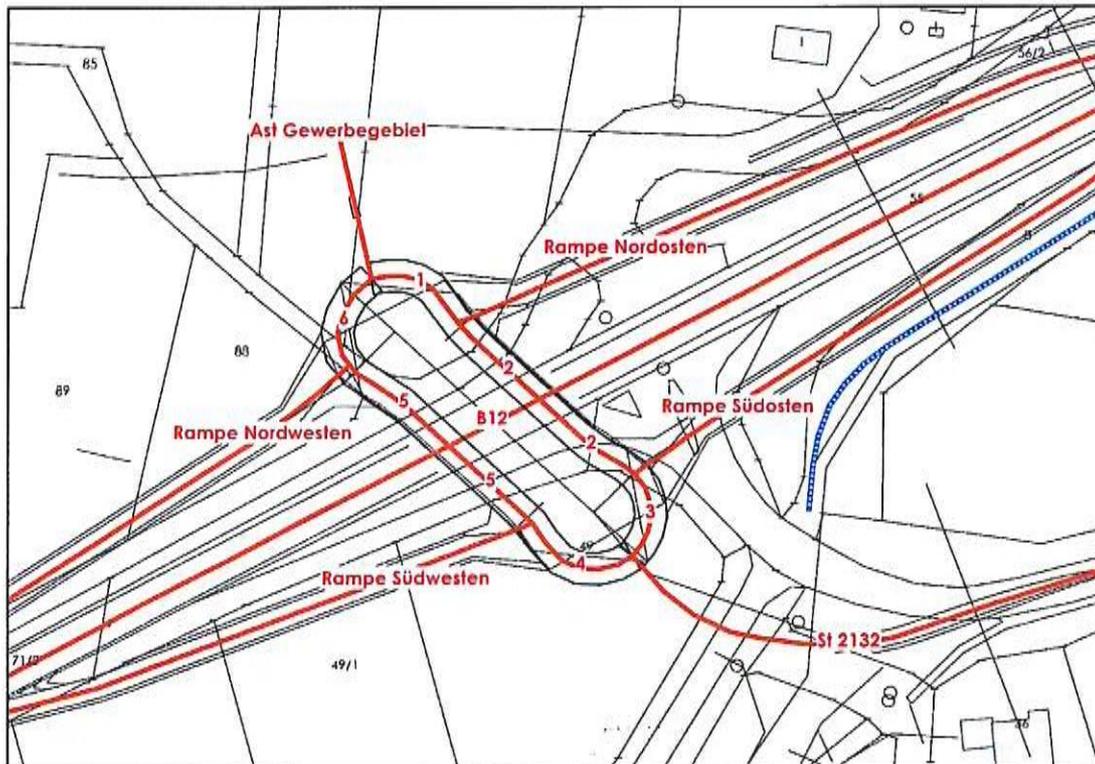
Lageplan mit Bezeichnung der relevanten Straßenabschnitte (Planungssituation)
